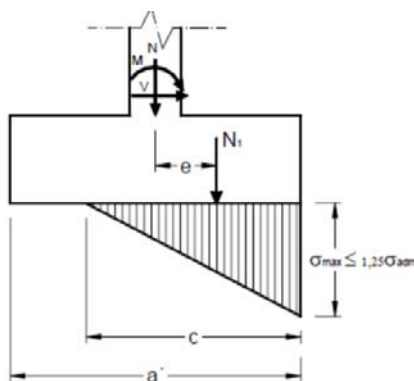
Detalle fuerza fuera núcleo central de la zapata
